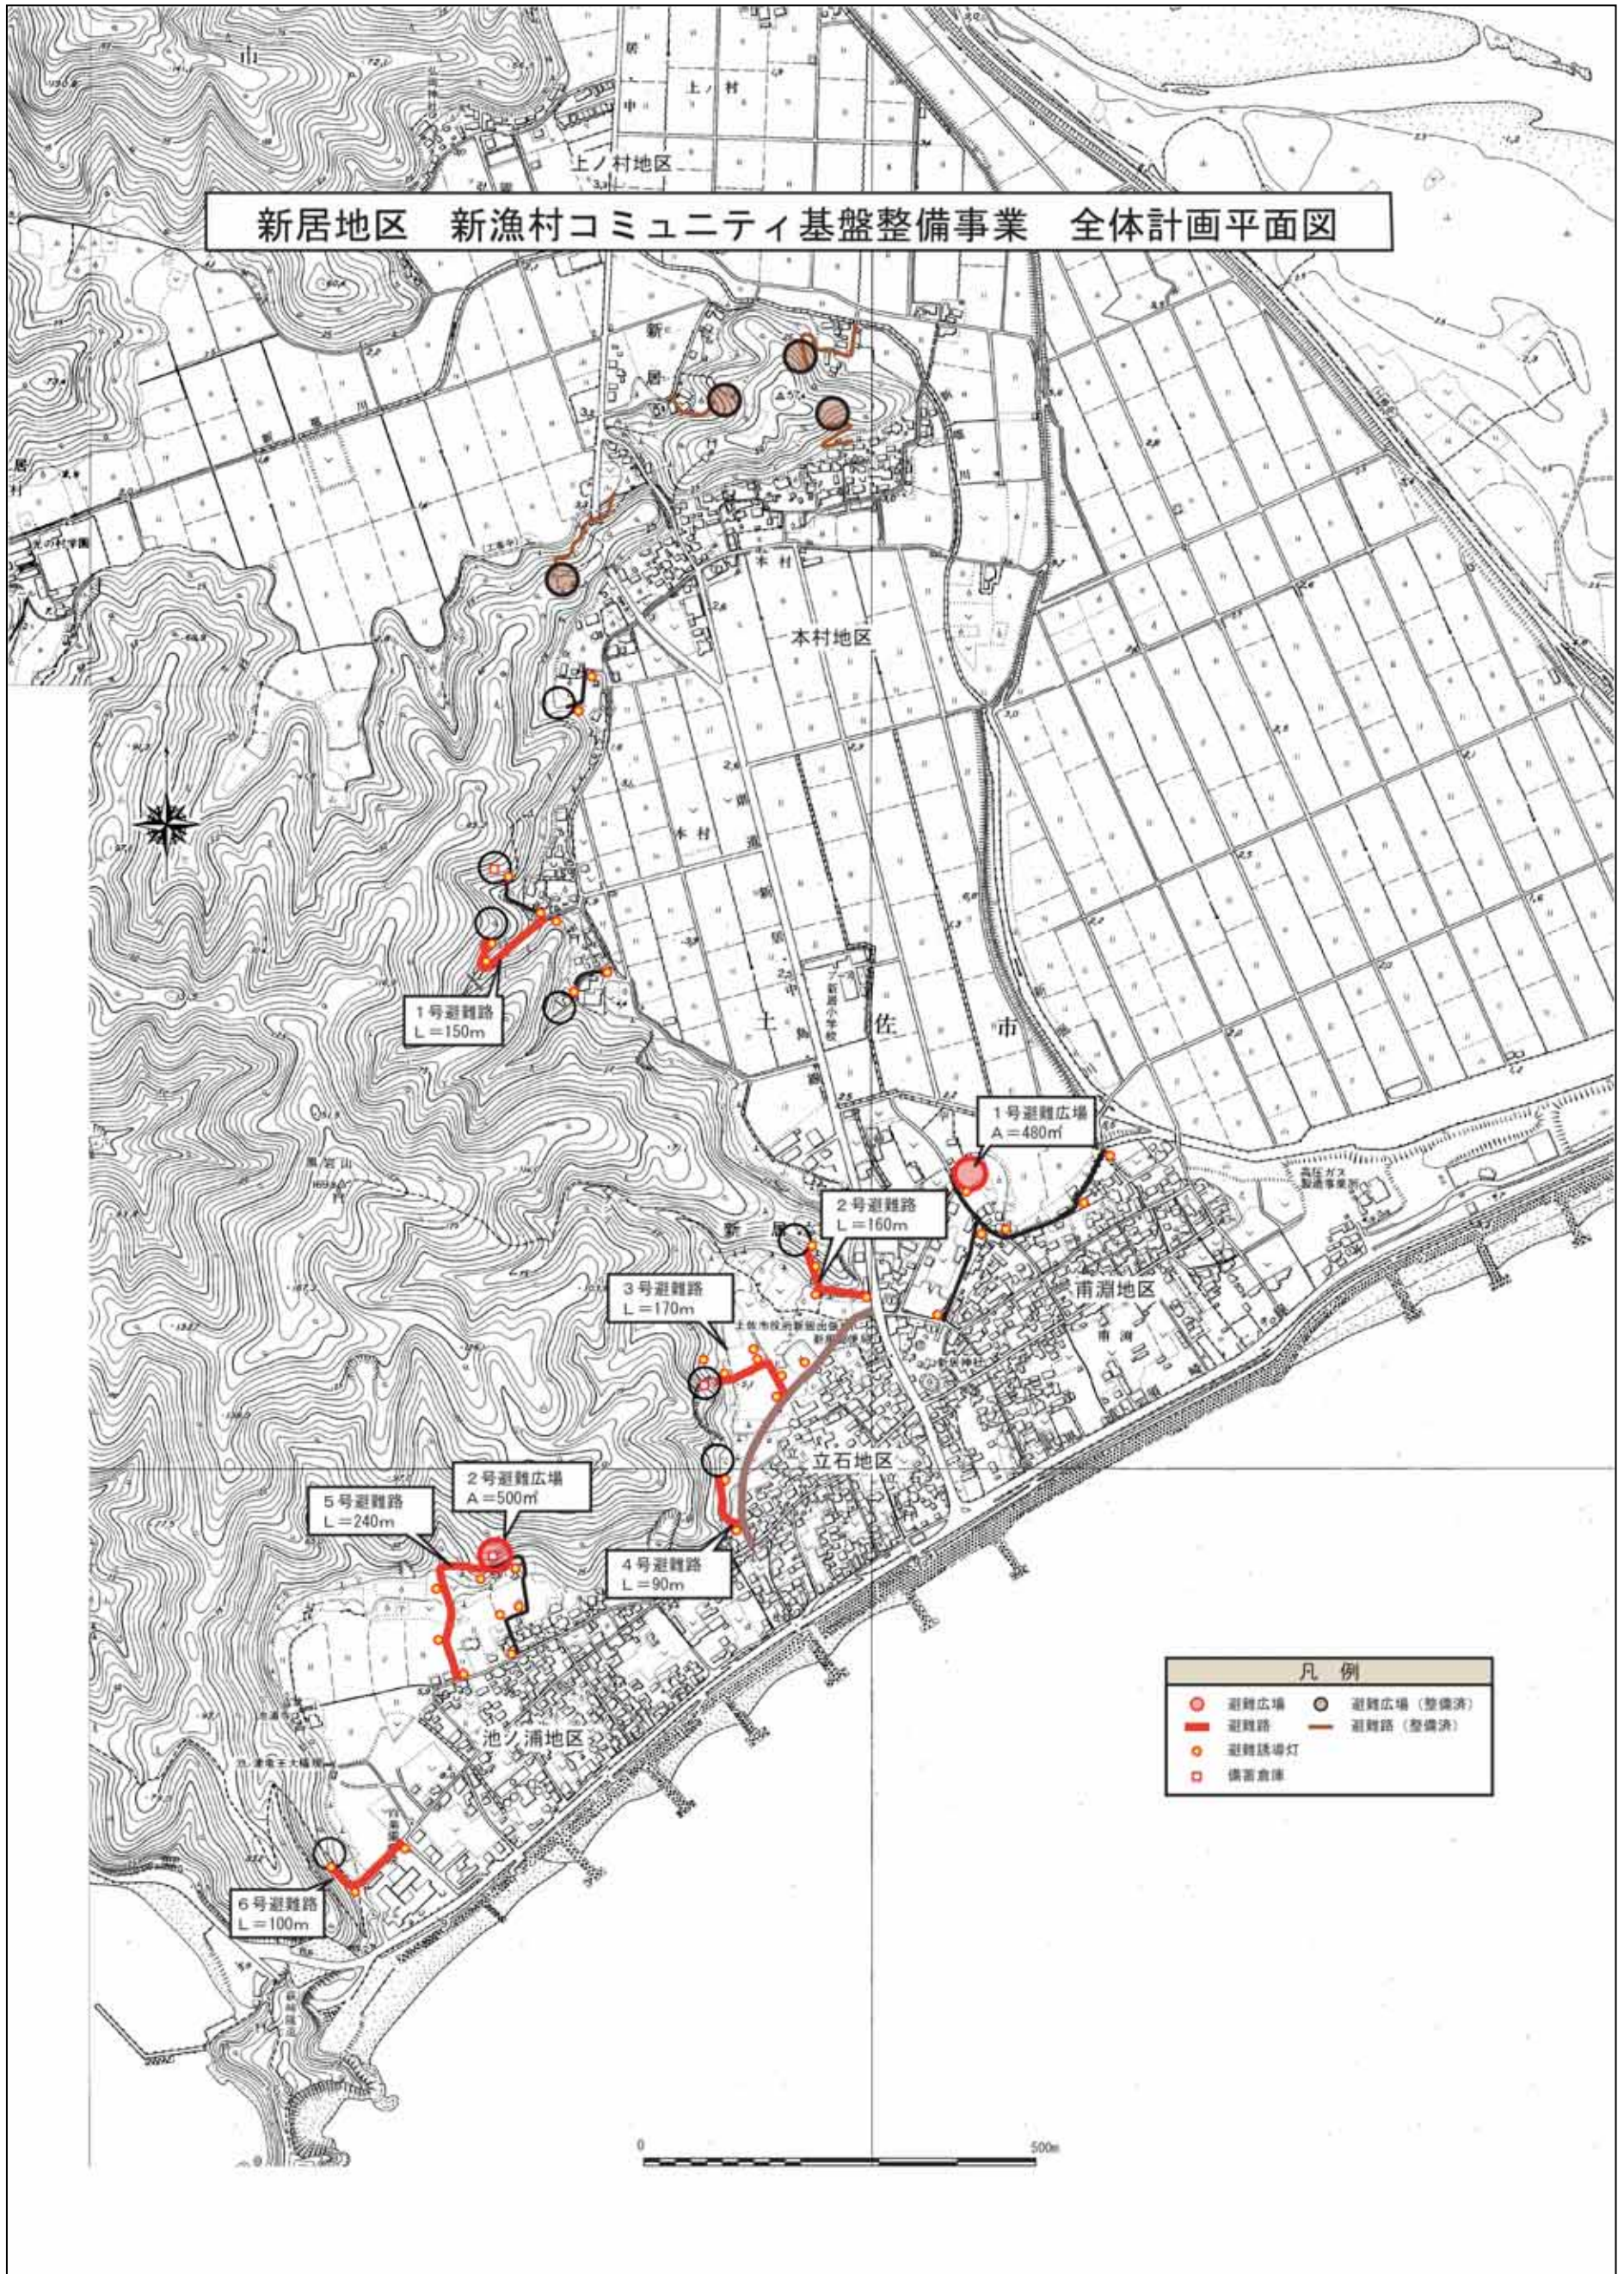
本整備計画での避難場所、避難路等の整備計画平面図
